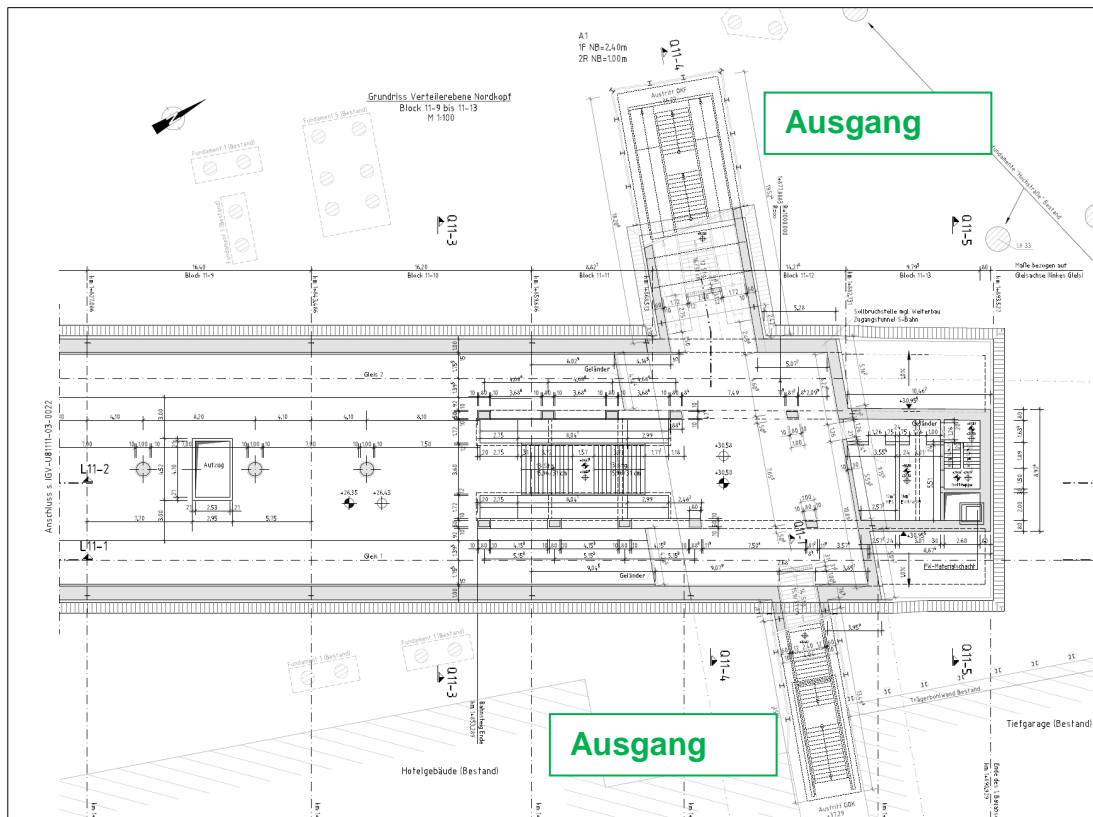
Grundriss Verteilerebene Nord - Auszug aus den Plangrundlagen (Quelle: IGV)
